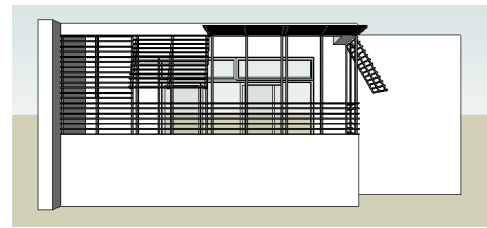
Esquema propuesta, caso 2, balcón, vista exterior
